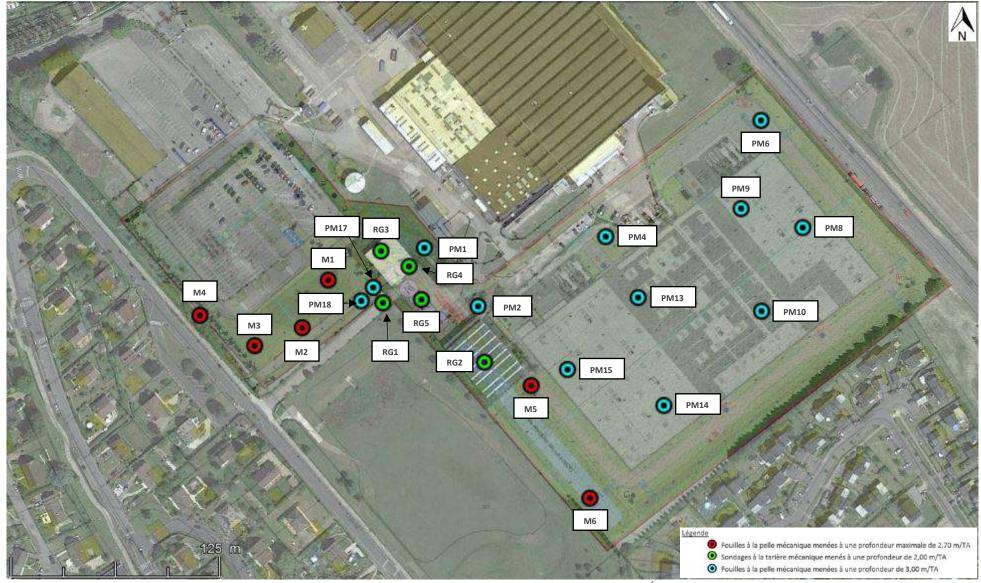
Plan de localisation des sondages sur le plan projet – étude GÉauPole
